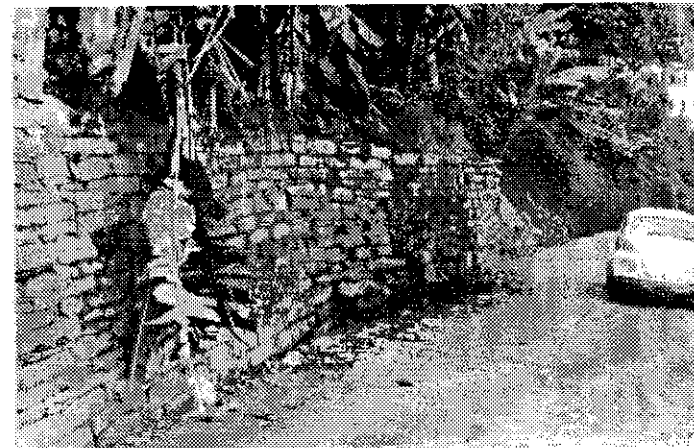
Muro de pedra seca na Rua Vitorino Dias.
